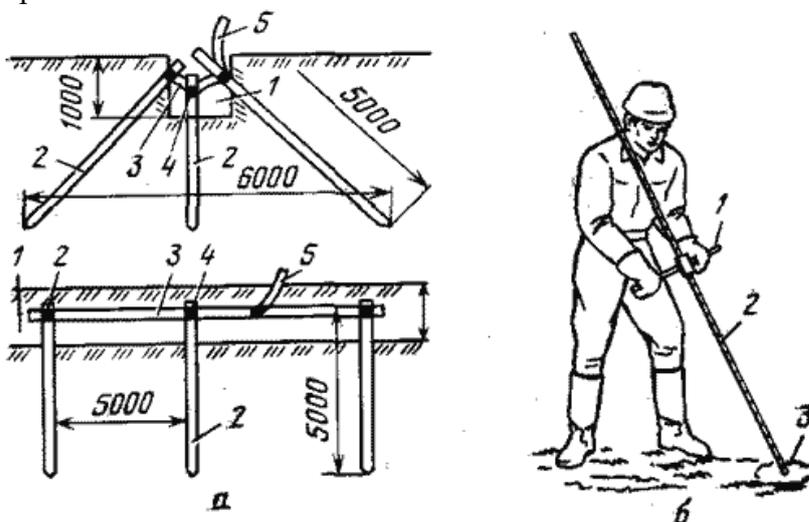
Монтаж заземляющего устройства КТП: а – конструктивные размеры заземляющего устройства из наклонных и вертикальных заземлителей: 1 - траншея; 2 - заземлители; 3 - перемычки; 4 - сварные соединения; 5 - заземляющие проводники; б - техника погружения наклонных заземлителей вручную: 1 - переставная ручка; 2 - штык; 3 - вода
